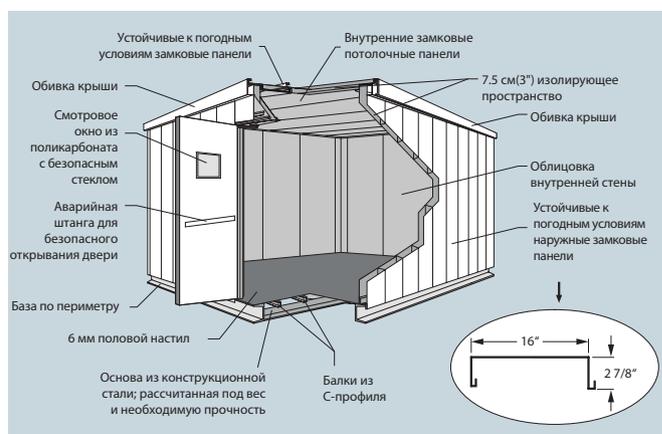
Наиболее часто используемая конструкция SIEHOUSE состоит из каркасной конструкции, стен, сцепленных замковыми соединениями и кровельных панелей, устанавливаемых на стальное основание.
